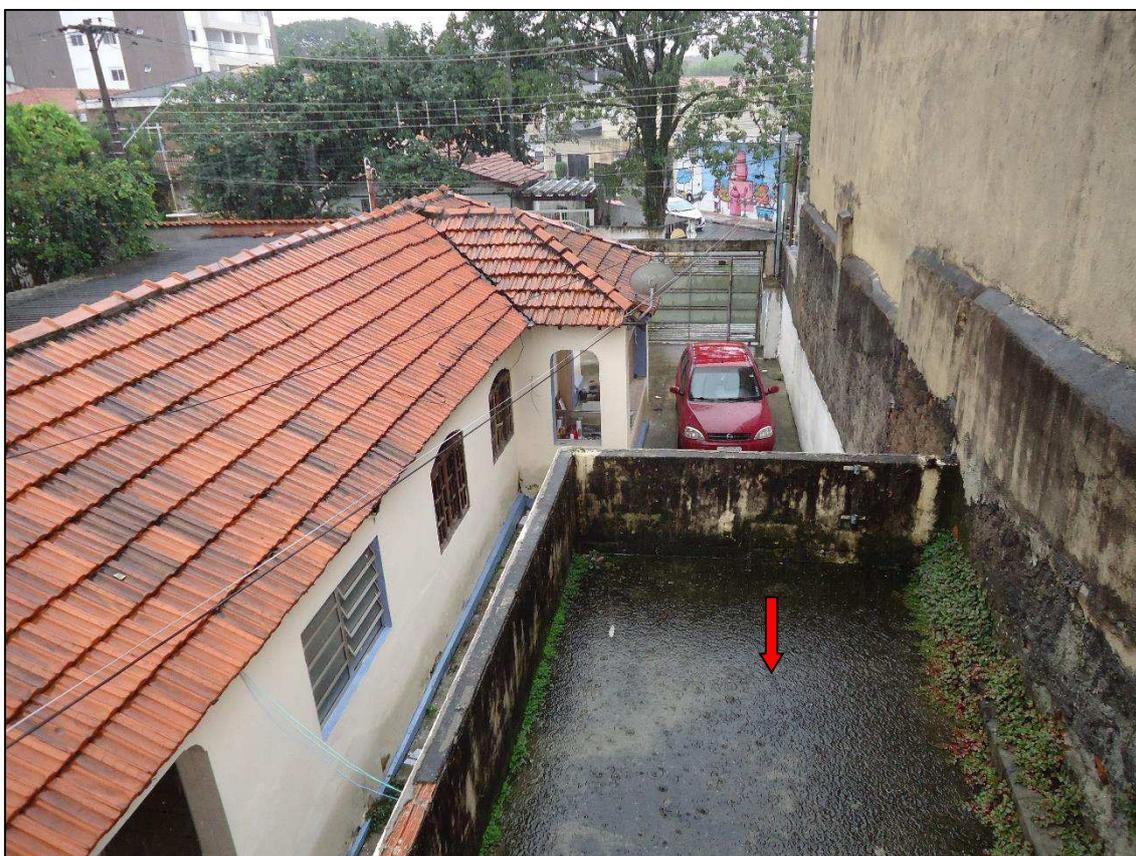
Vista da área superior da área de serviço (lavanderia) externa (destacada).
